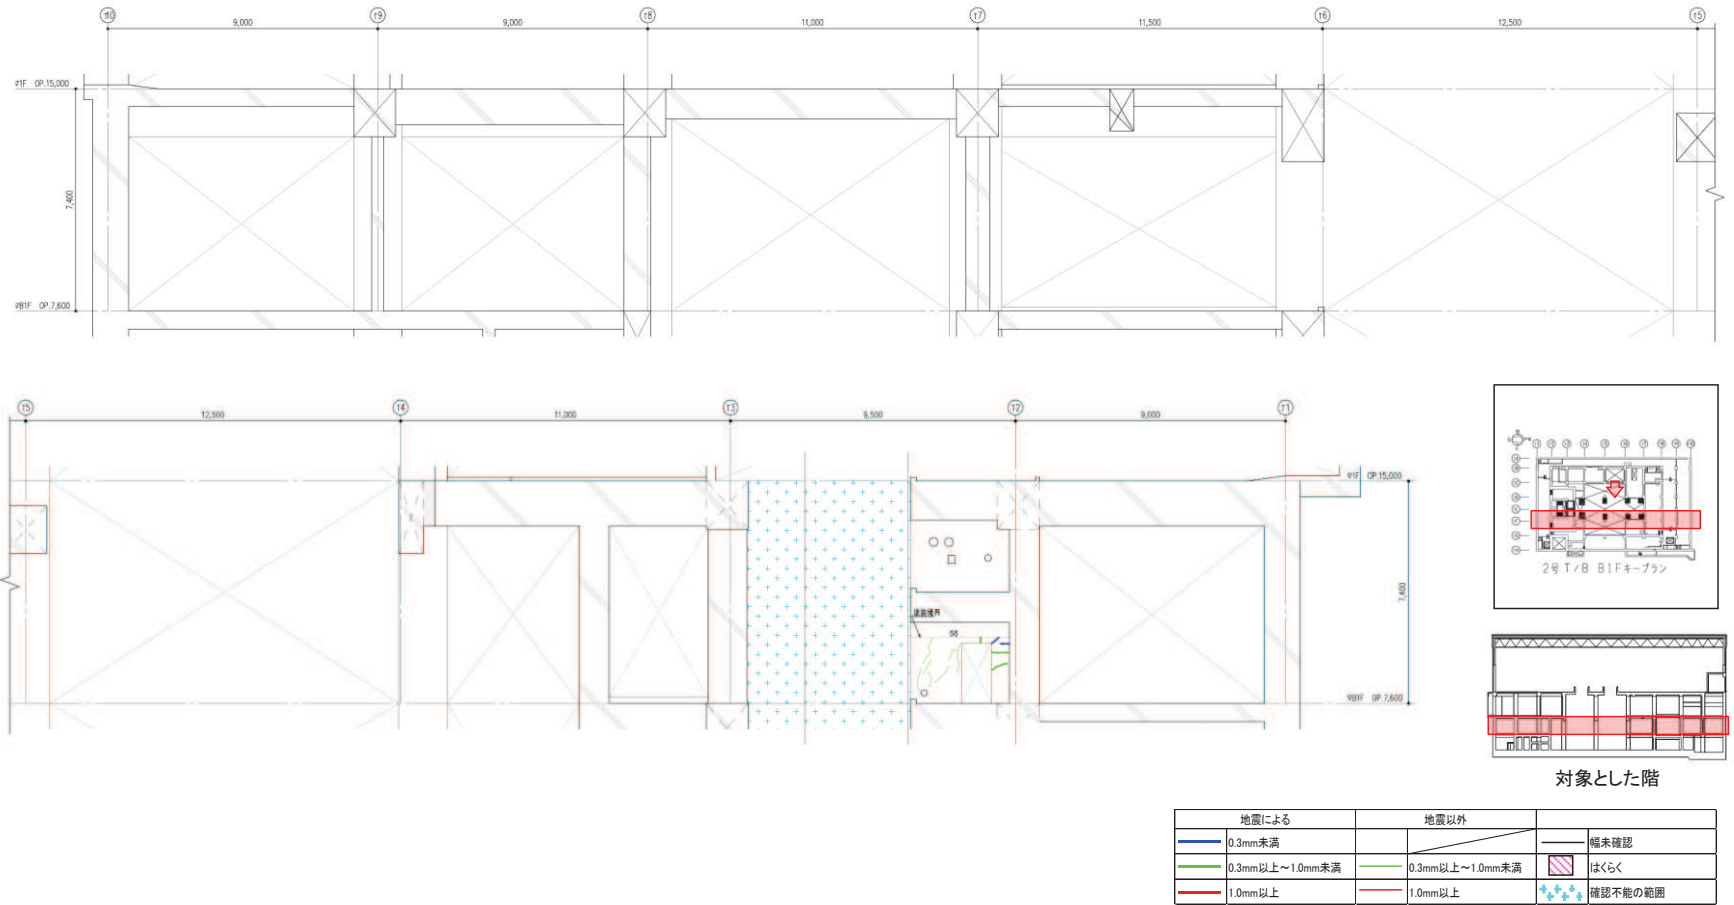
タービン建屋のひび割れ分布 耐震壁 (30) 地下1階 TF 通り
